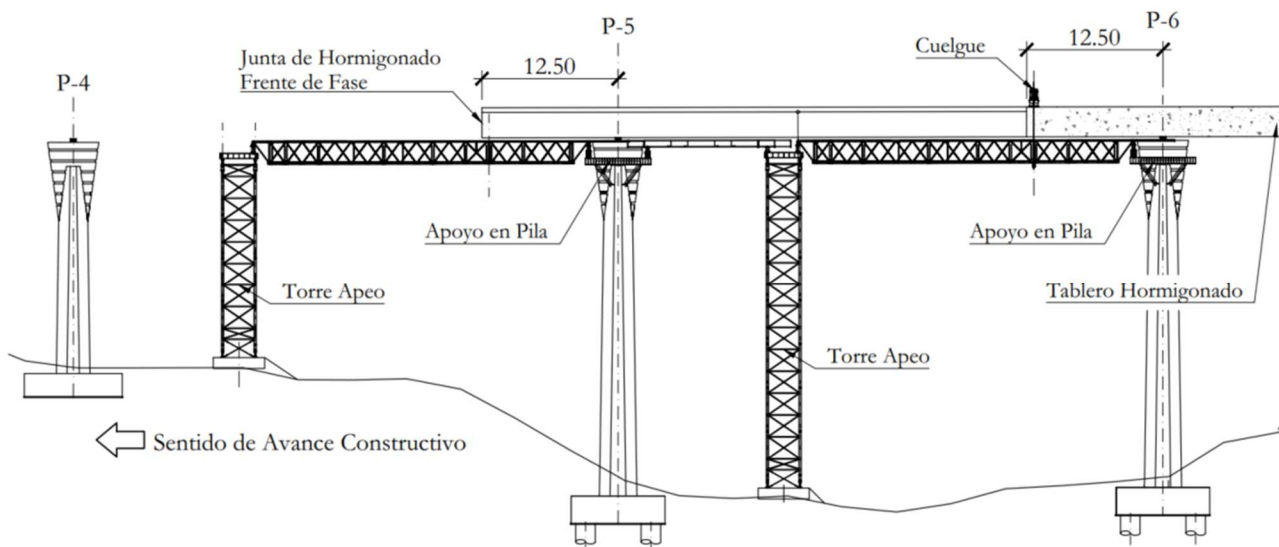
Esquema constructivo del vano tipo con cimbra porticada.
